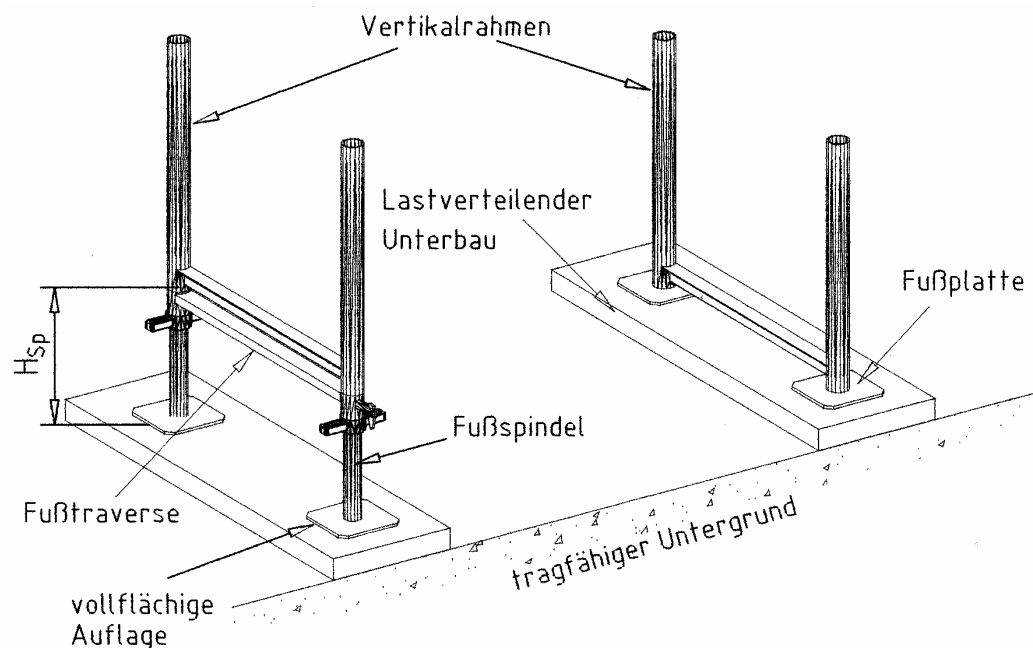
Lastverteilernder Unterbau mit Gerüstbohlen
